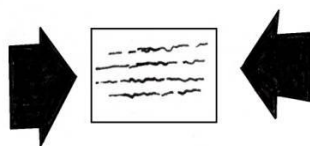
Detalle de fisura por un esfuerzo a compresión.
